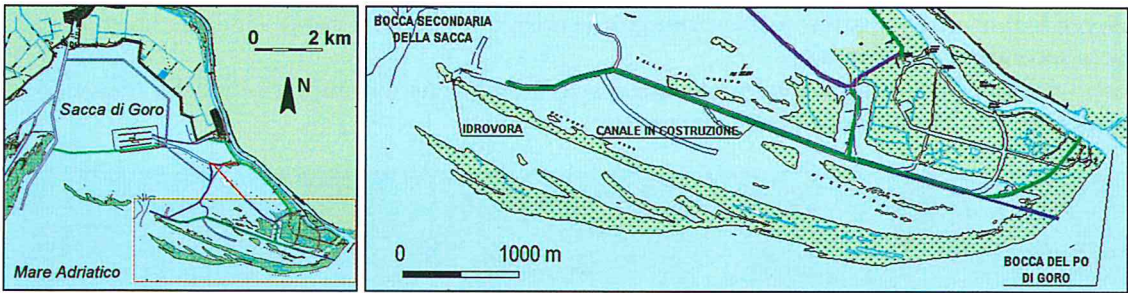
Planimetria complessiva della Sacca di Goro (a sinistra) e planimetria della zona di intervento con indicazione del tracciato del canale in costruzione.
